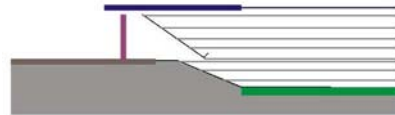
planimetria vertical da relação entre implantação/acesso, envelope, coberta e arquibancadas para o exemplar de São Paulo
